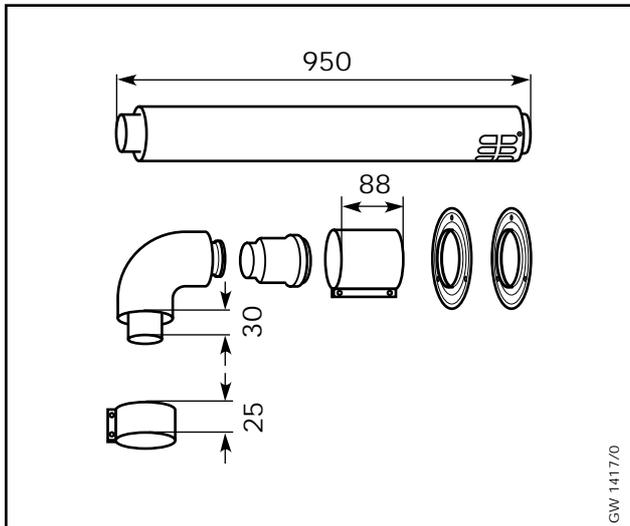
Waagerechte Wand-/Dachdurchführung
